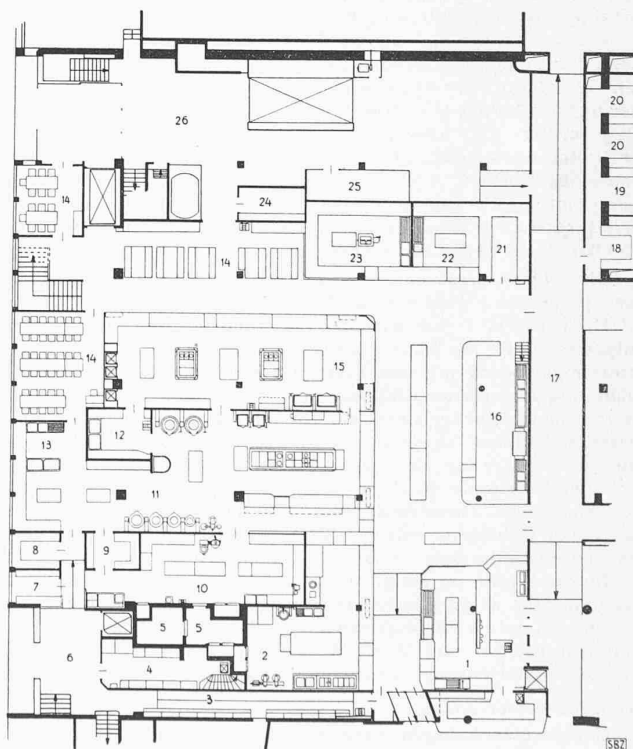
Kongresshaus-Küche, Grundriss 1:400.
